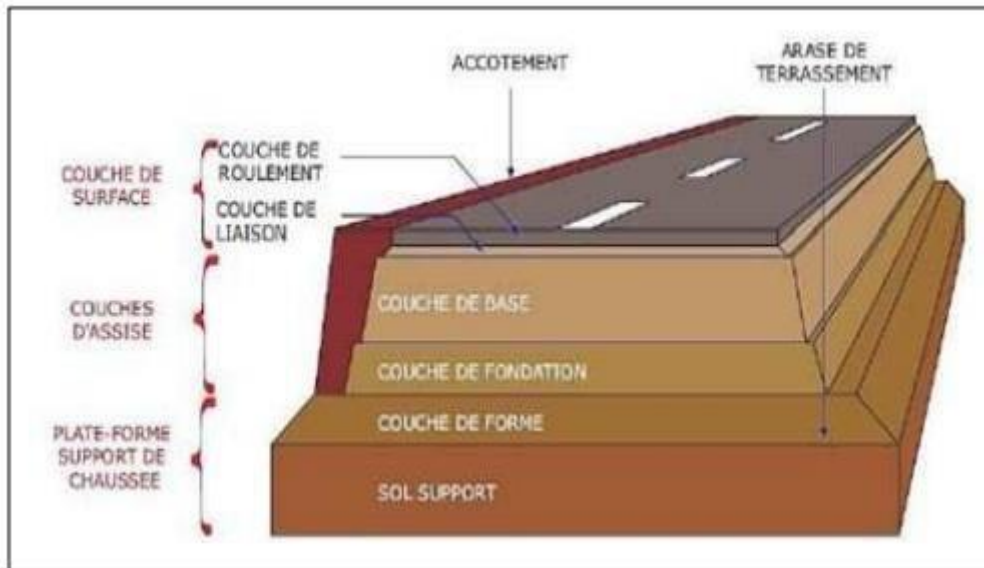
Les différentes couches d'une chaussée (Pouteau, 2004) [5].
